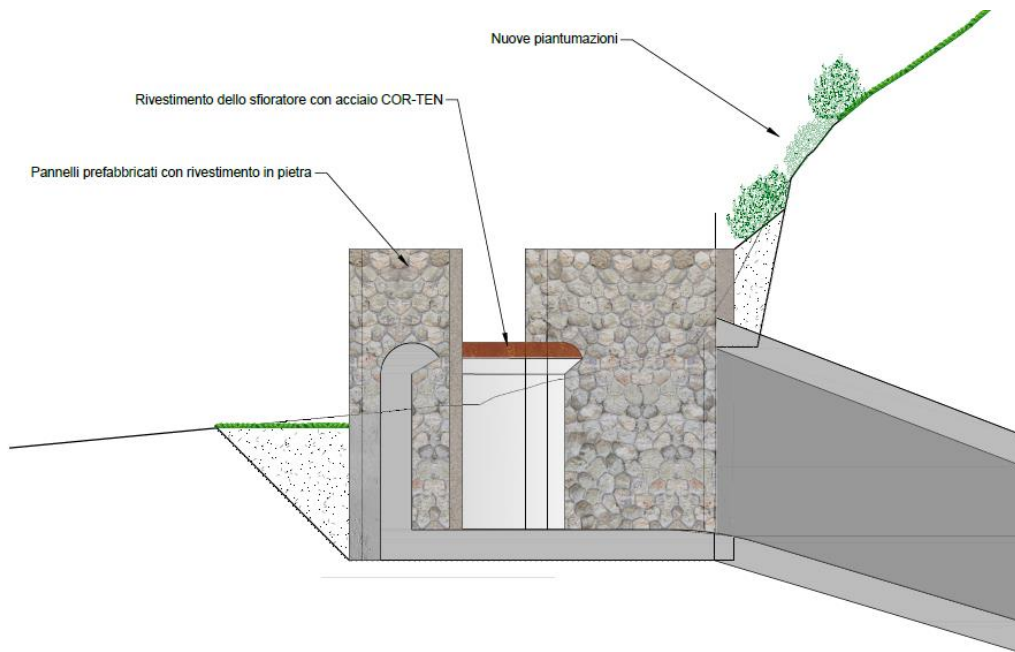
Sezione tipo con interventi di mitigazione su opera di presa
